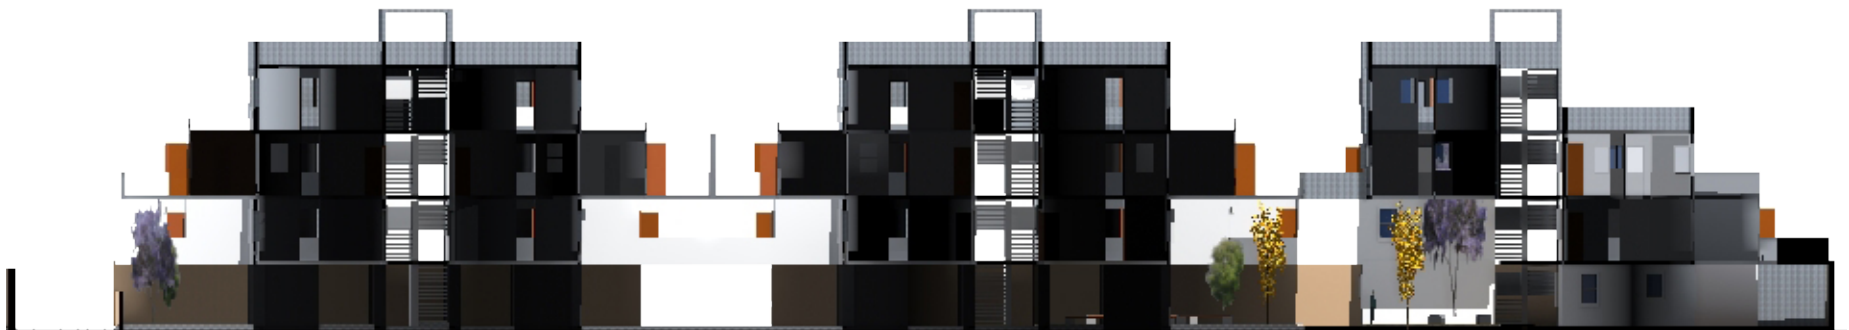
Corte Interior Longitudinal Norte - Sur
